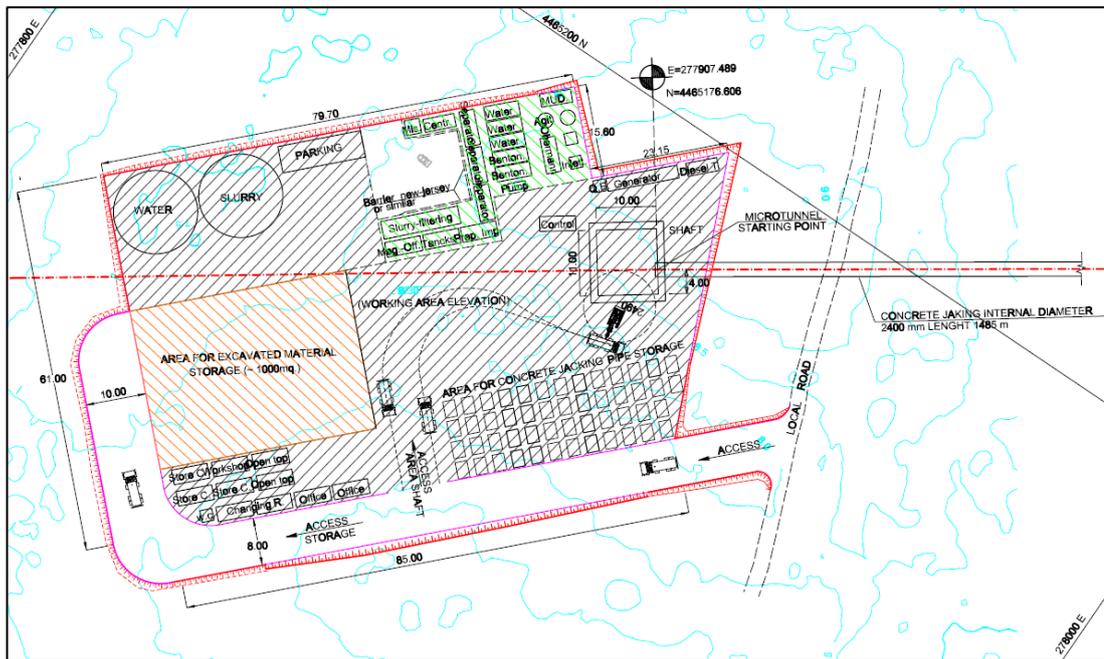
Schema delle apparecchiature utilizzate nell'area di cantiere e nell'area di stoccaggio.
